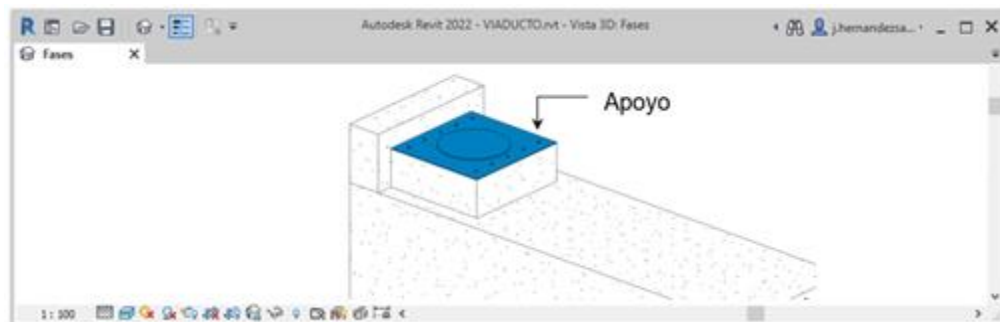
Creación de Apoyos. Fuente: Elaboración propia
